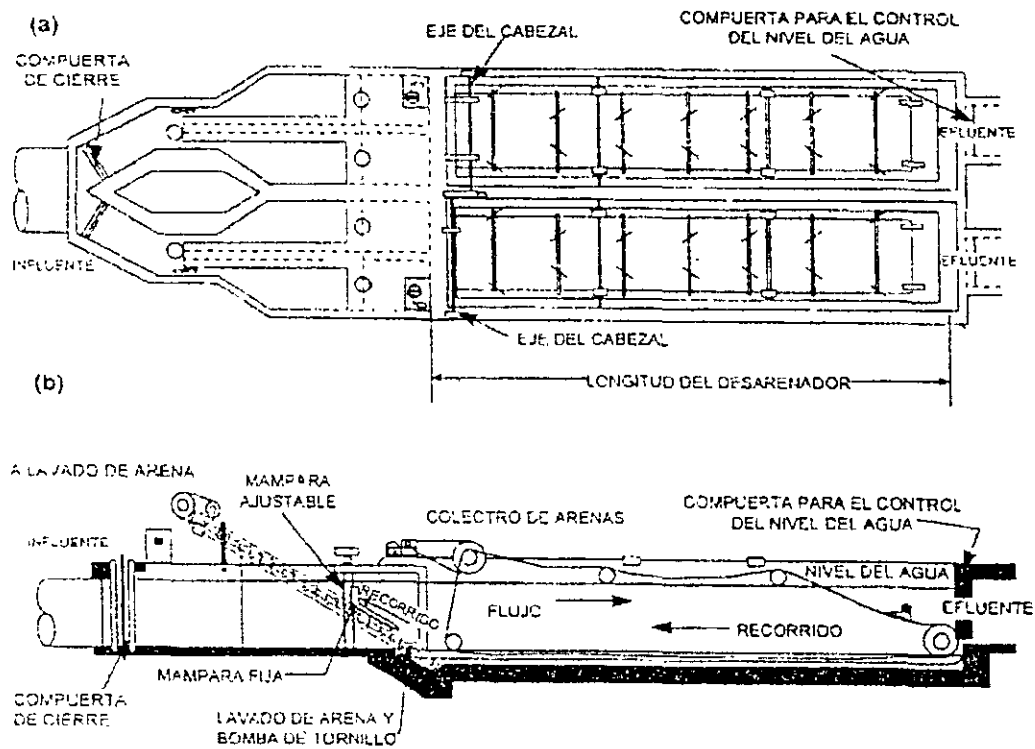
Planta y sección longitudinal de un desarenador de doble canal con depósito.
